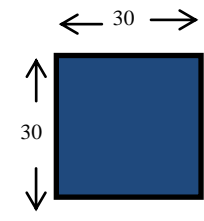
Dimensions des sections de béton des poteaux et des poutres
